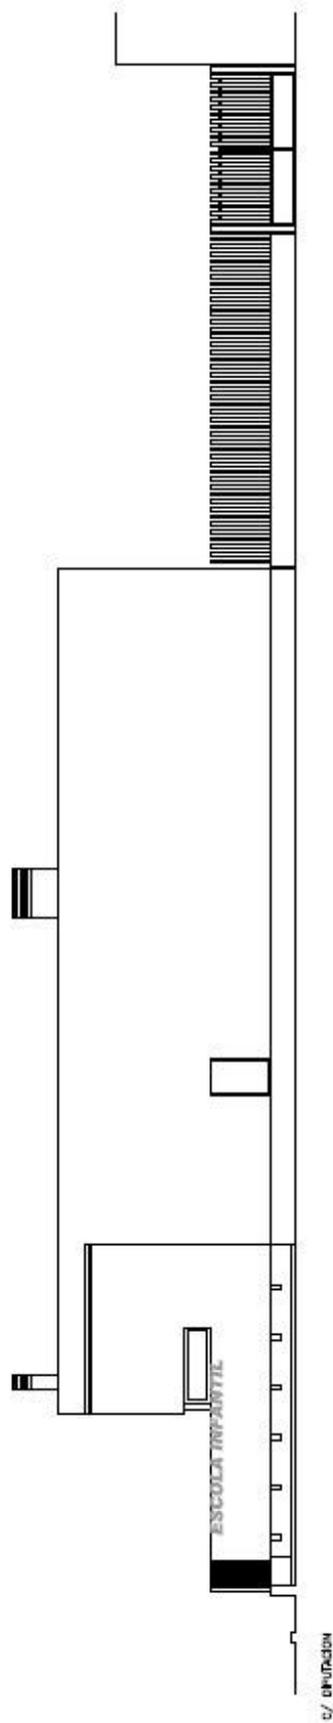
Alzado Calle Diputación (plano sin escala)
